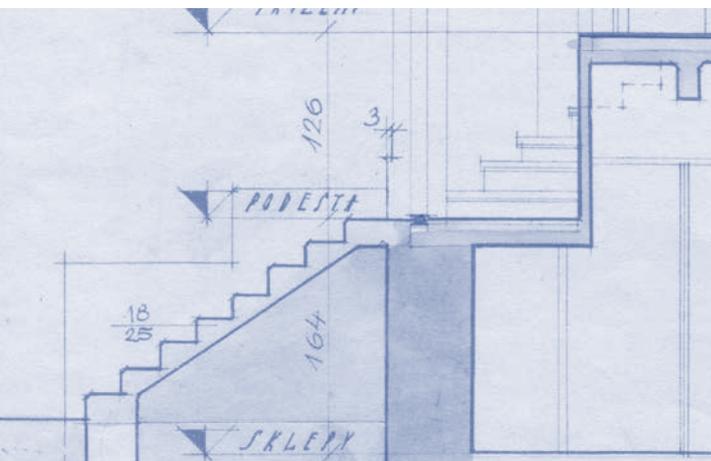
Entwurf Haupteingang Haus Müllers, 1927, Bauplan, Privatarchiv Villa Müller
